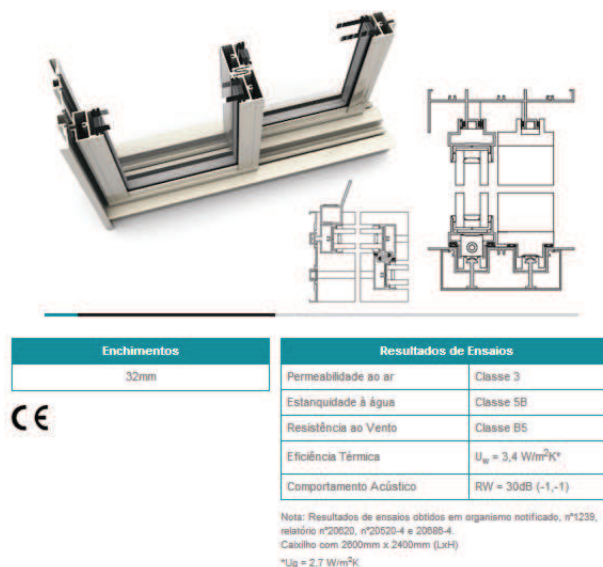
Propriedades da caixilharia Arkial Slimside prevista em projeto (Sapagroup)
